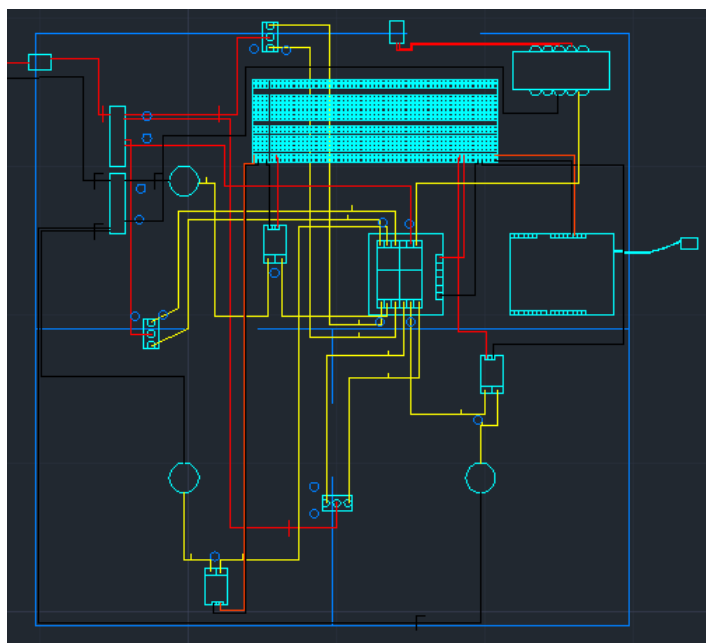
Desenho da planta no Autocad. Fonte: Autor.
